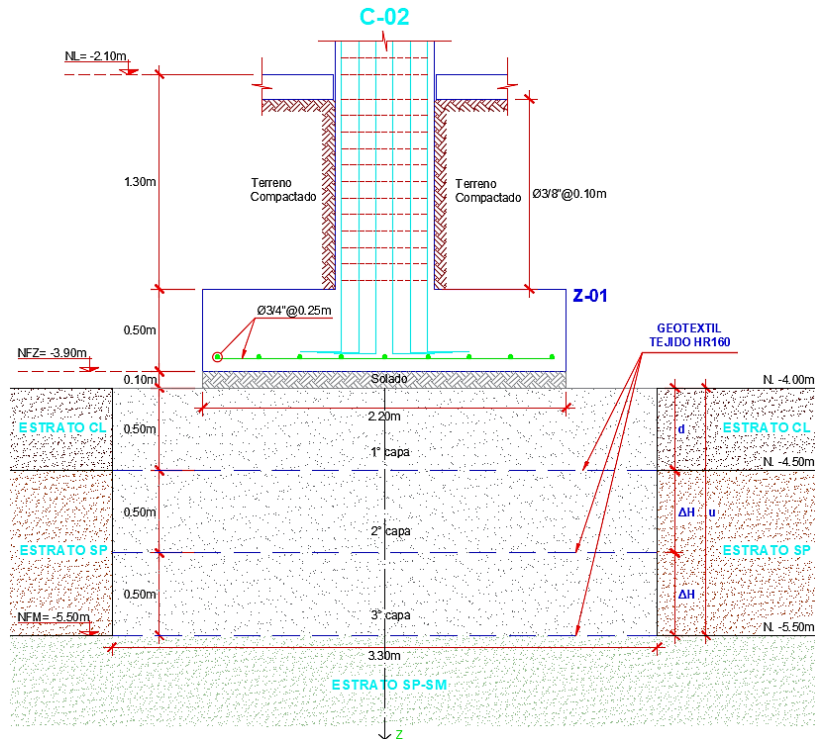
Detalle del mejoramiento de suelos con geotextil de la zapata aislada vista en elevación
